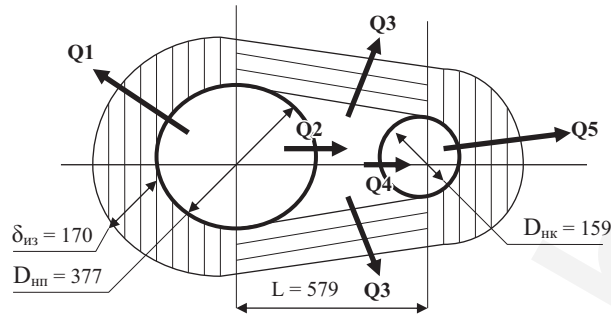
Конструкция общей тепловой изоляции паропровода и конденсатопровода
